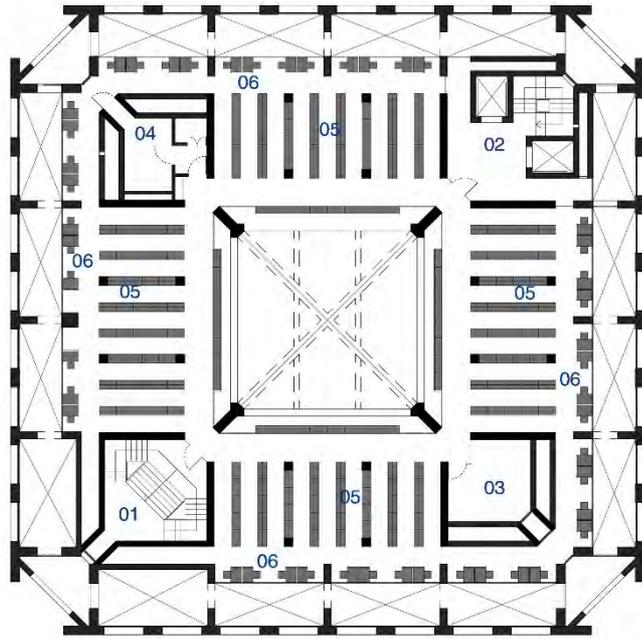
| Planta do quinto e do sétimo pavimentos (mezanino) [redesenho do autor]
